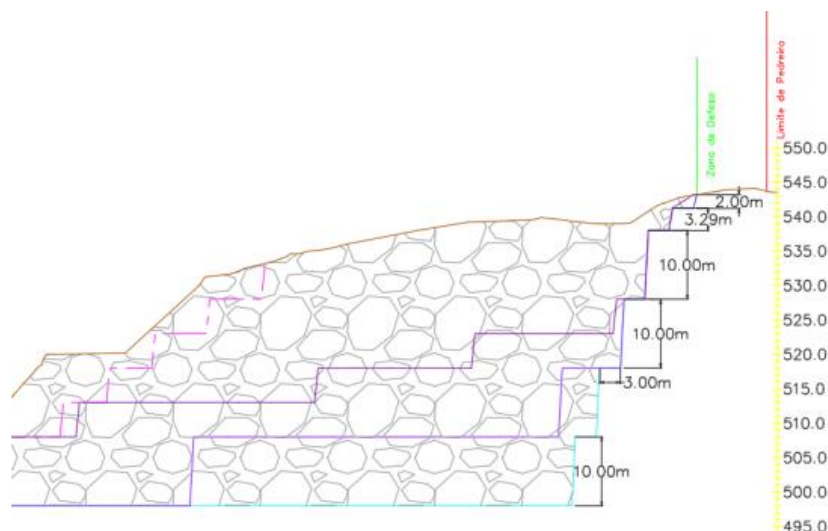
Configuração das bancadas. Fonte: Plano de Pedreira
